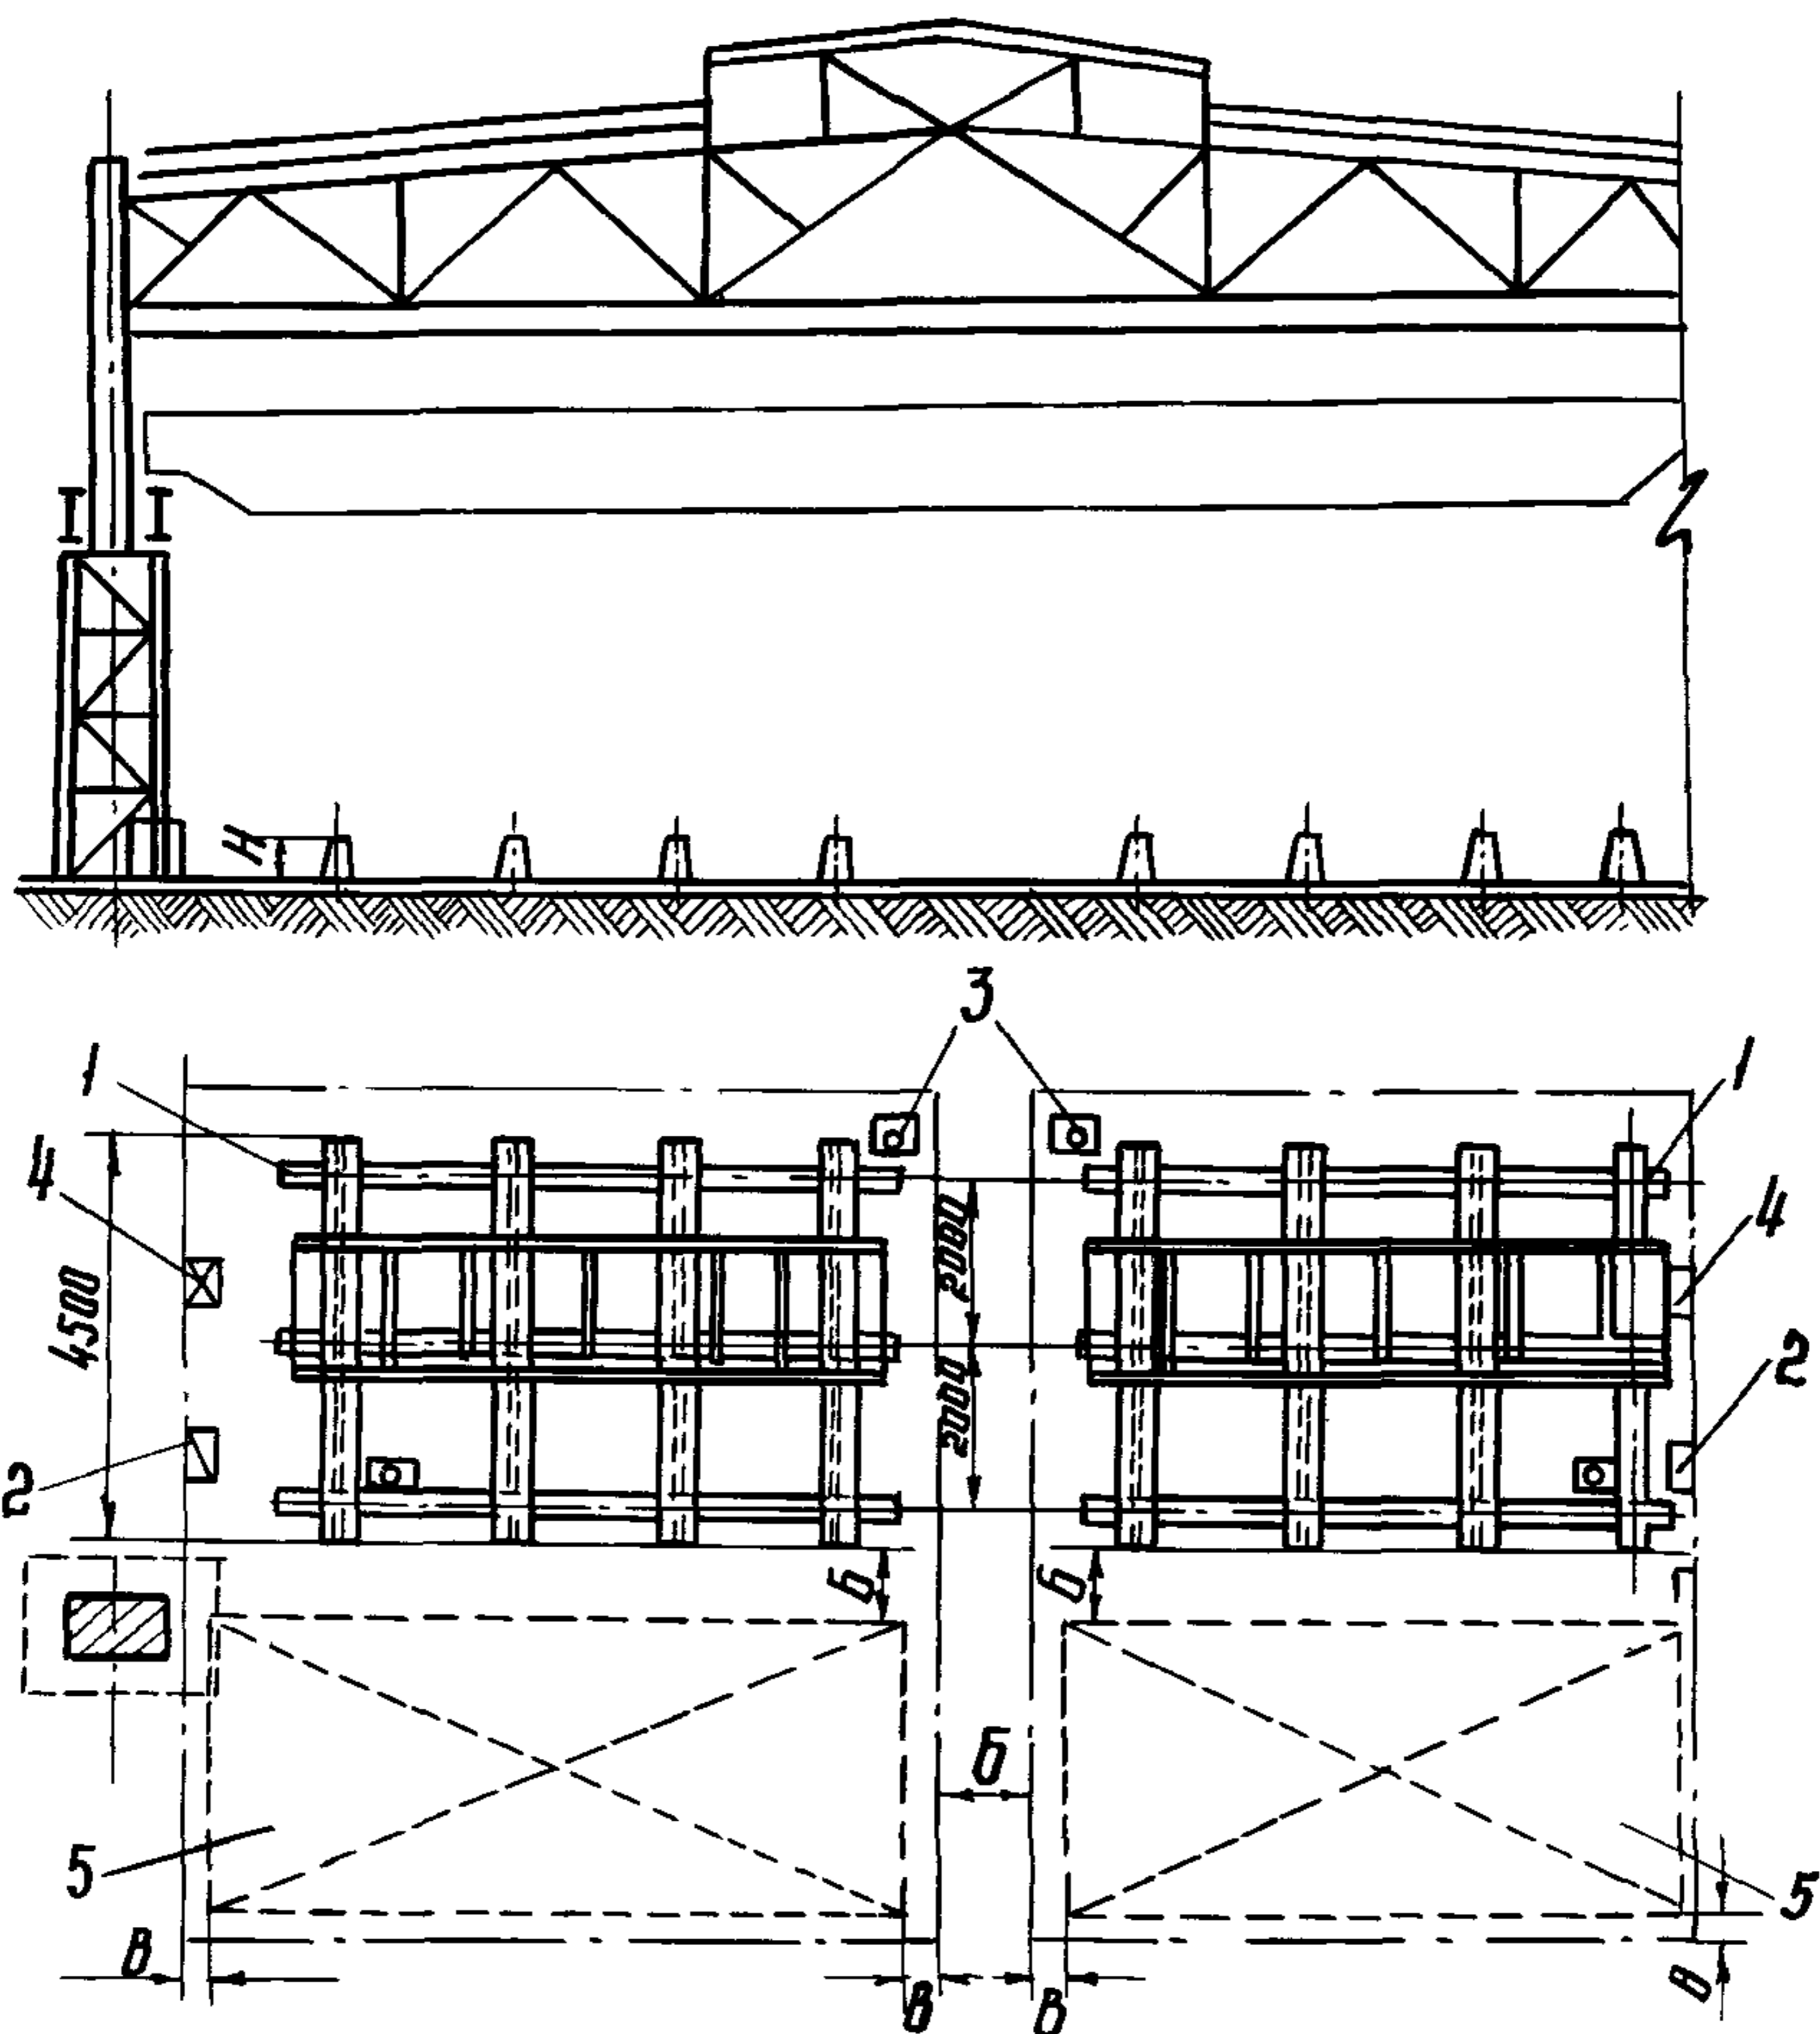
Размещение стенда для сварки из козелков в поперечном пролете:
